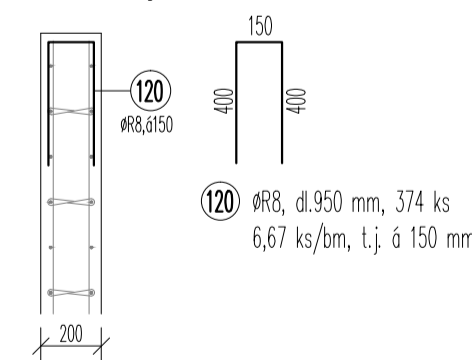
DETAIL VYZTUŽENÍ SCHOD. STĚNY
